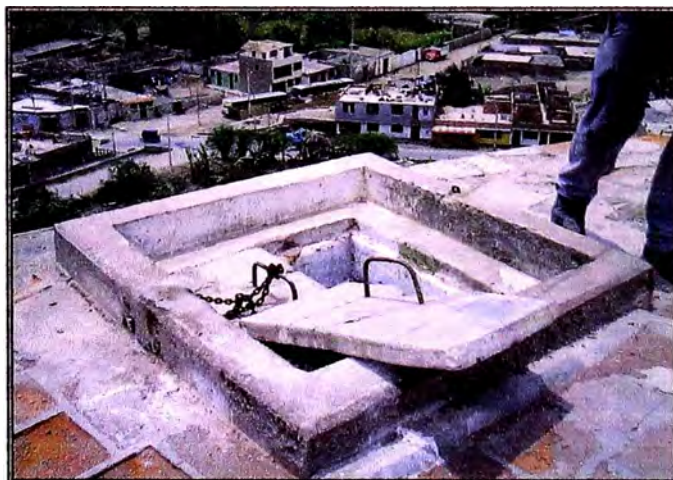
En la vista, se ve la Tapa Sanitaria del Reservorio Apoyado (R400) y el deterioro del ladrillo pastelero en el techo.
